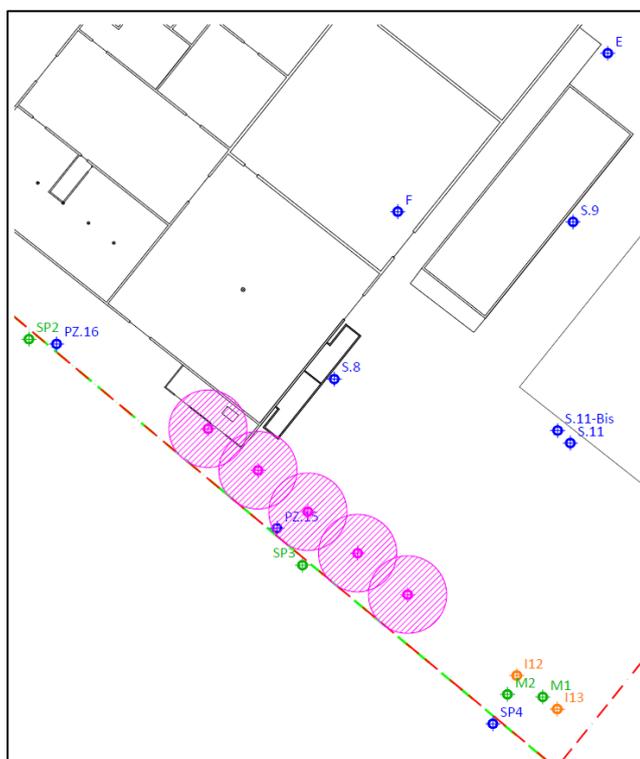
Planimetria pozzi sistema sparging ed aree di influenza.
